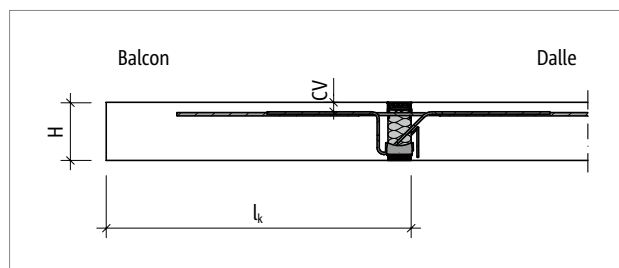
Schöck Isokorb® T Type K-E, K-T : Système statique, coupe
